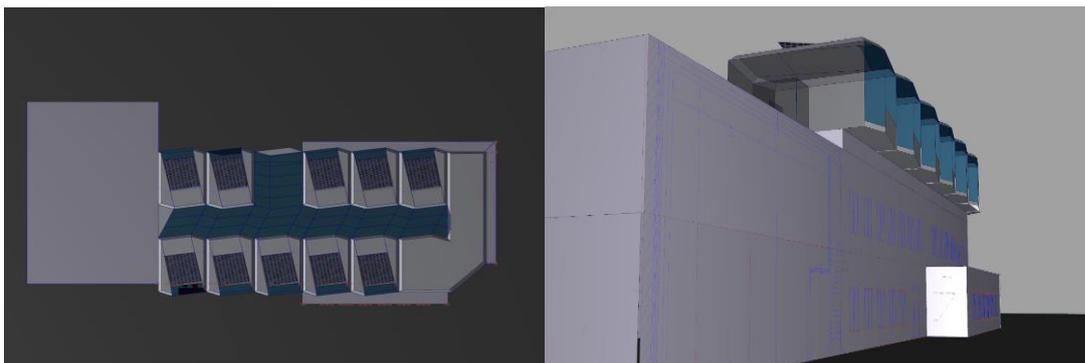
Raum-, und Flächen Dachflächen PV Anlagen Ansicht Eingang Vorderseite überkragender Containeraufbau
